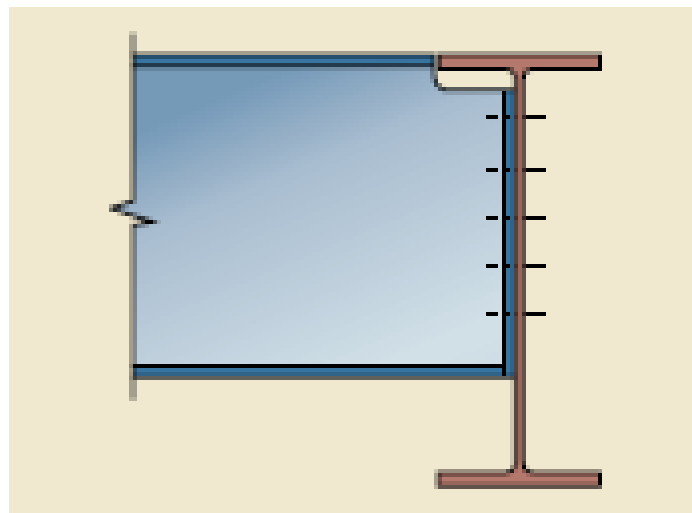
Unión viga-viga con rebaje en viga secundaria
